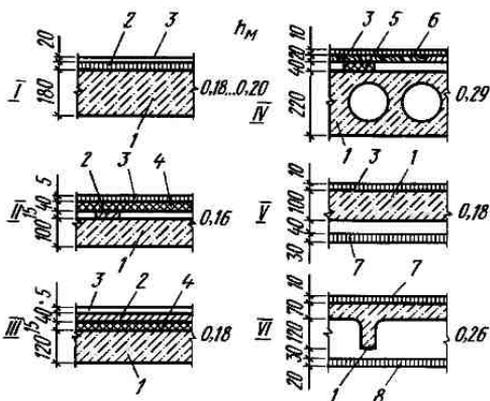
Типы панельных междуэтажных перекрытий и полов по ним:
